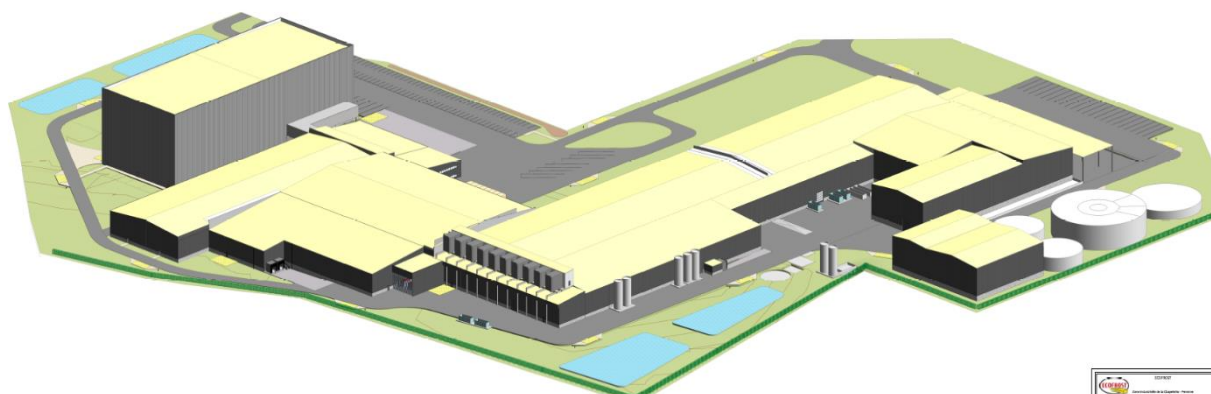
Plan 3D de l'installation (Source : Aconstruct, novembre 2021)
